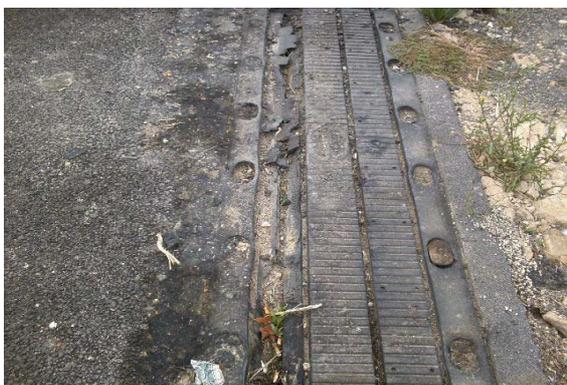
Junta de calzada deteriorada o inexistencia de junta de calzada
